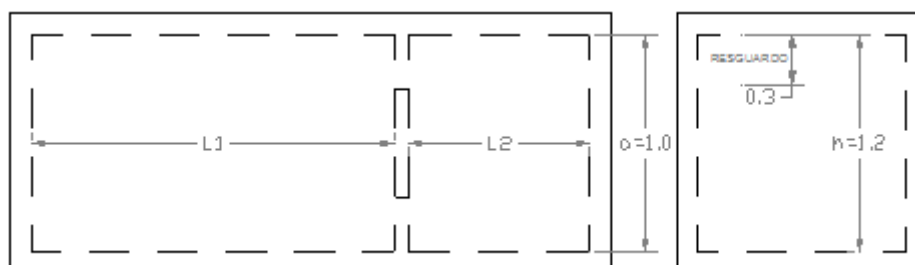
Secciones típicas en planta y alzado de una fosa séptica de hormigón, con las cotas en metros. Cortesía: *Aguas de Galicia*.
